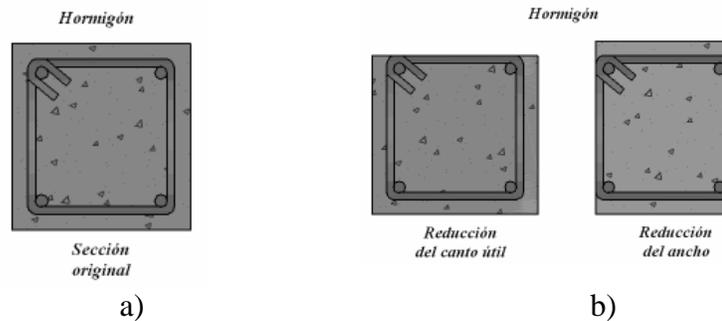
a) Sección Inicial de Hormigón. b) Sección Residual de Hormigón.
